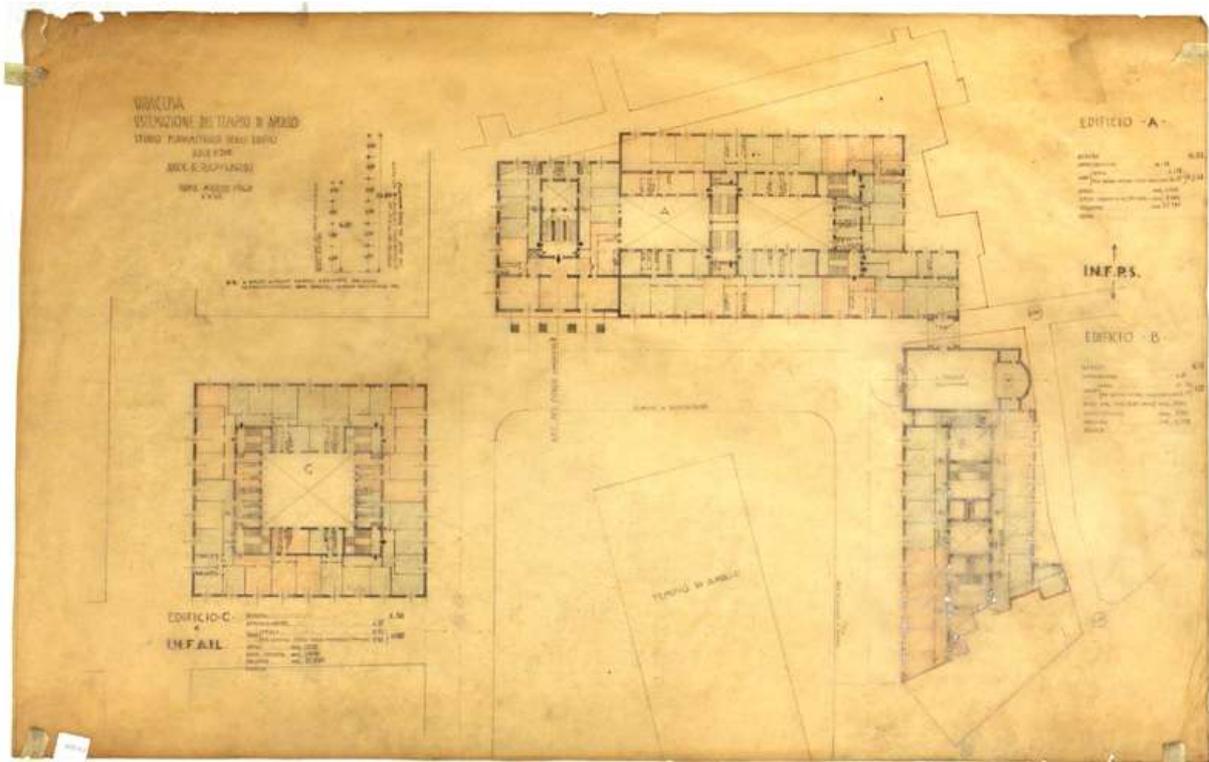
Siracusa, Sistemazione del Tempio di Apollo. Studio planimetrico degli edifici dell'architetto Gaetano Rapisardi, 1940 (APR, Archivio Privato Rapisardi).
